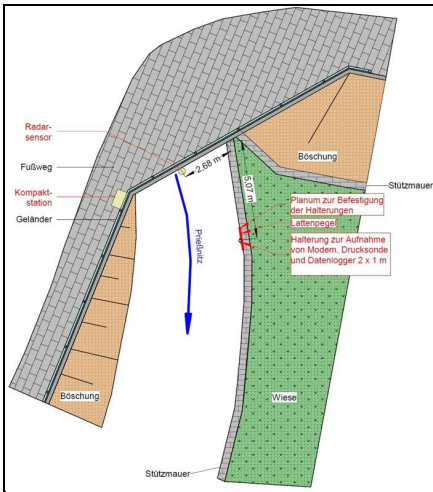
Planung - Lageplan Messstellen-Standort 89 Prielwitz, 09.03.2018
